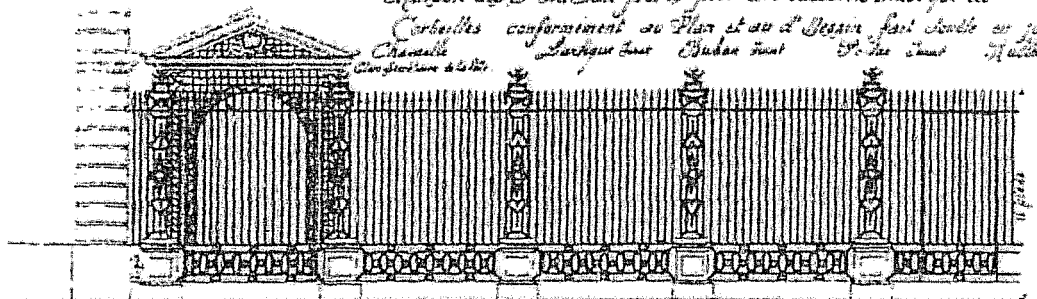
Elévation de la Halle aux Poids .A.D. Girondé C 1232.
